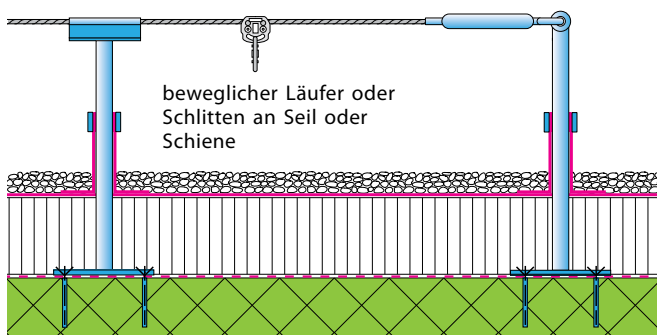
Ausstattungsstufe 2: permanentes horizontales überfahrbares Seilsystem mit Spannvorrichtung, direkt in Stahlbeton verankert
